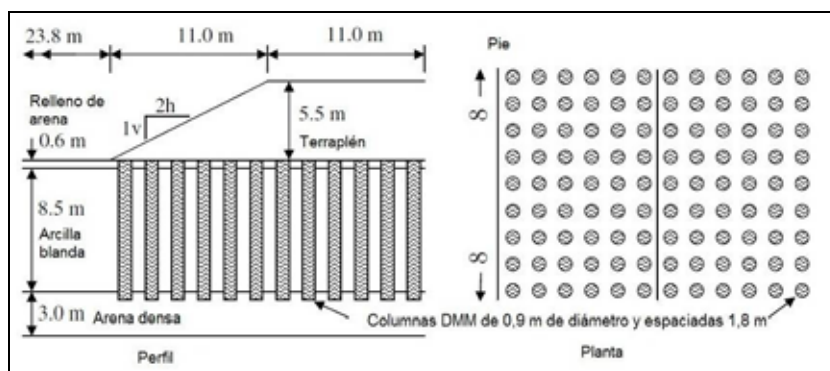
Sección y planta del terraplén sobre grupo de columnas DMM (adaptado de Navin y Filz, 2006).
